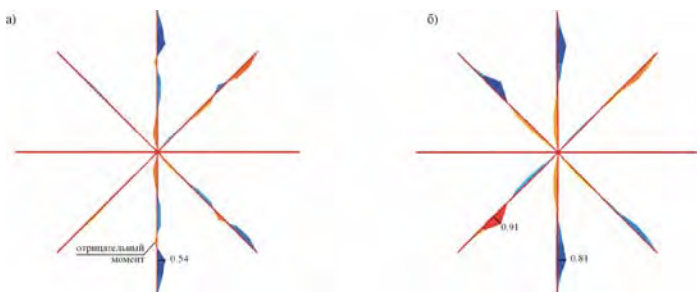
Эпюры моментов в стержнях верхнего пояса относительно вертикальных осей, M_w : *a* — конструкция покрытия с установленными связями по нижнему поясу (рис. 7); *б* — связи отсутствуют
